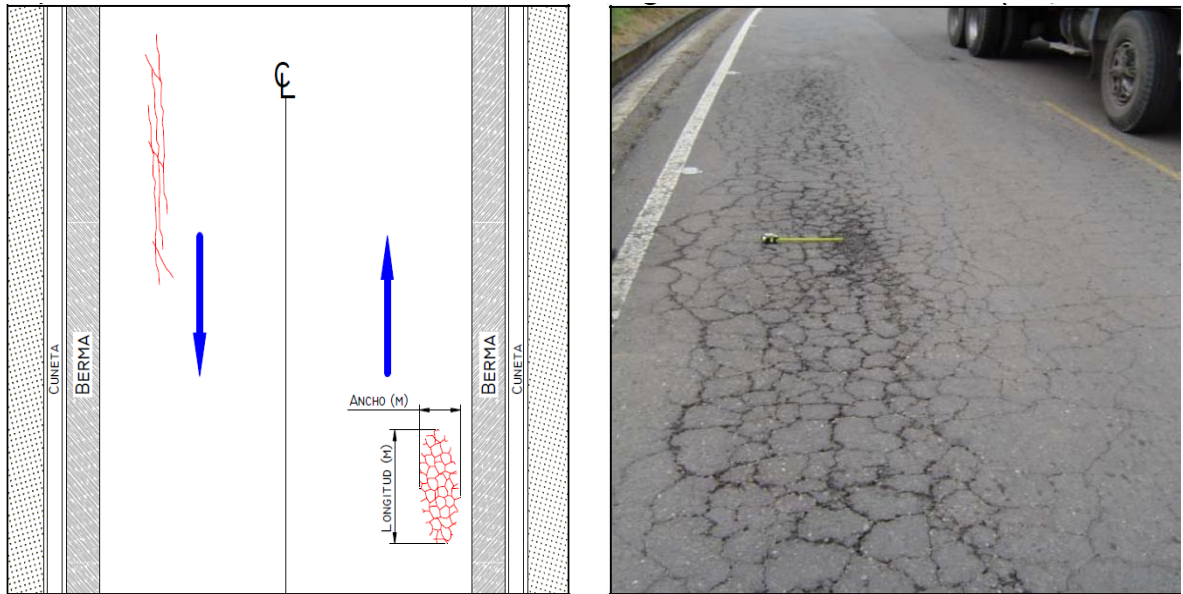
Fisuras Piel de Cocodrilo.
